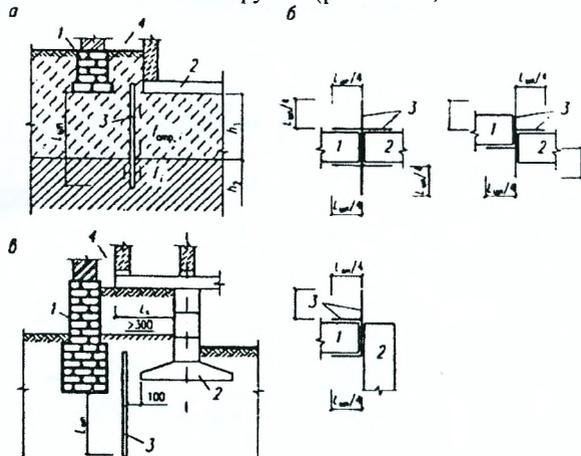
Решения консольных примыканий новых зданий к соседним существующим
